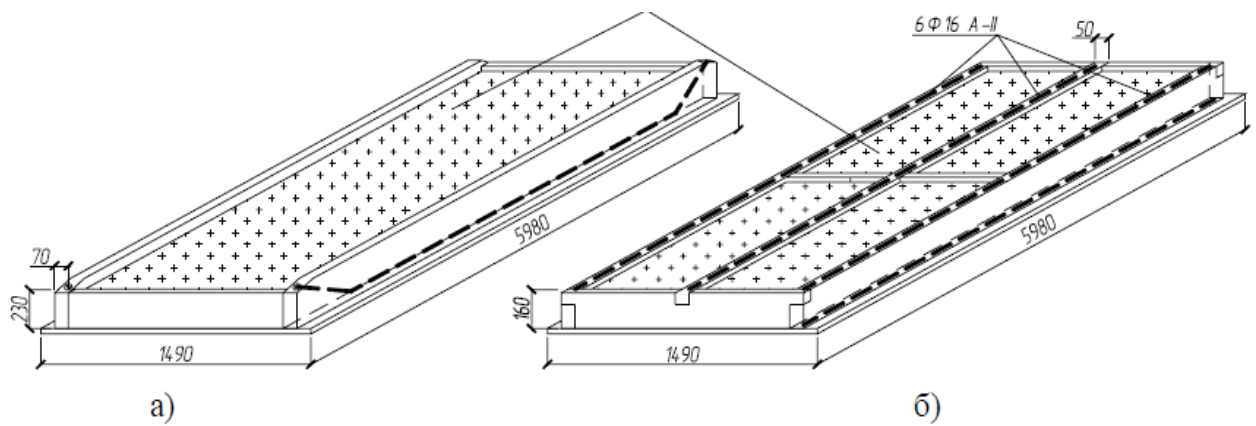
Плити покриття з армованим дерев'яним каркасом та азбестоцементною нижньою обшивкою: а – арматура в ребрах плити з попереднім напруженням; б – ребра плити армовані без попереднього напруження.
